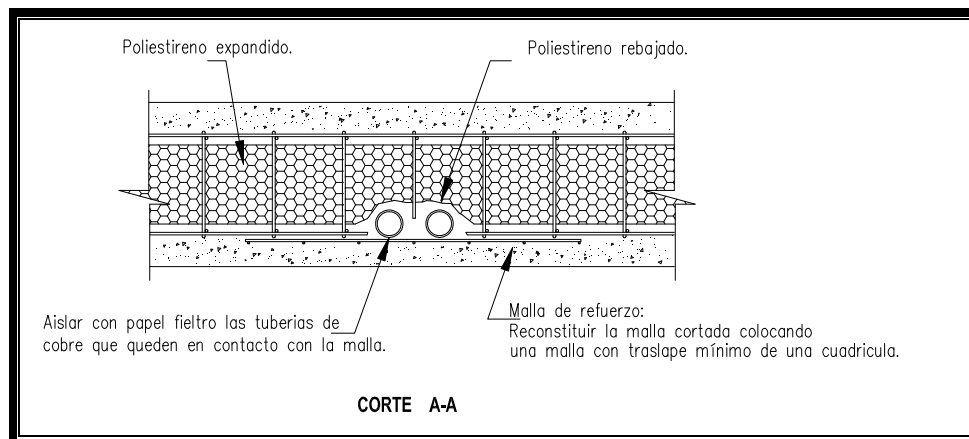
Detalle de Instalación hidráulica sobre muro estructural (Planta)
